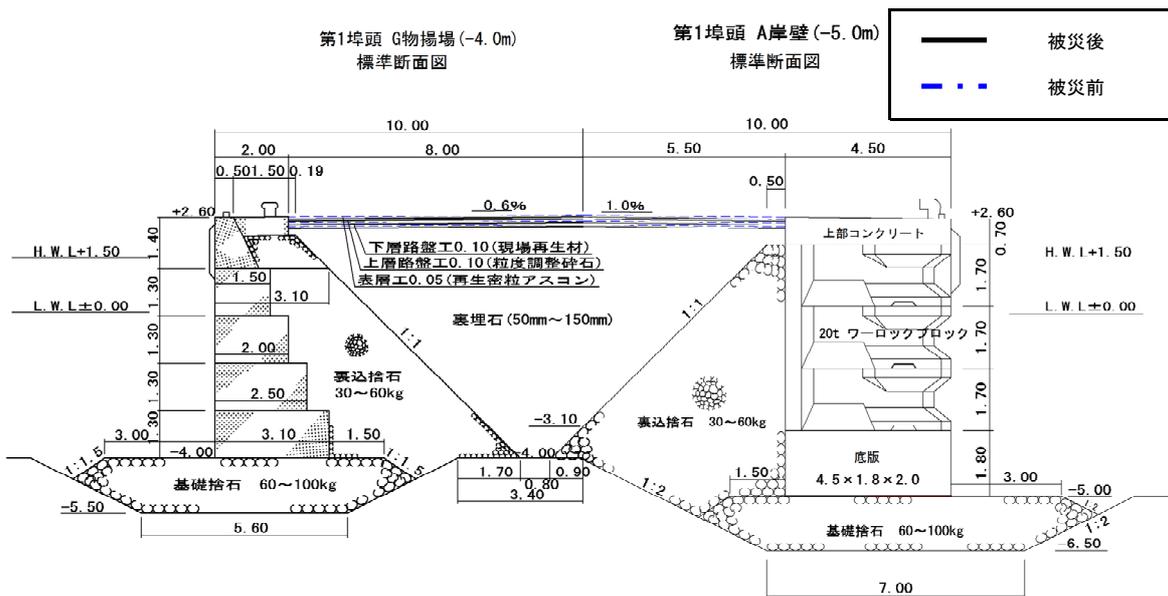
No.27 No.28 大洗港区_第1埠頭 A岸壁 (-5m) ・ G物揚場 (-4m) (水産ふ頭地区) の断面図 (被災後)
